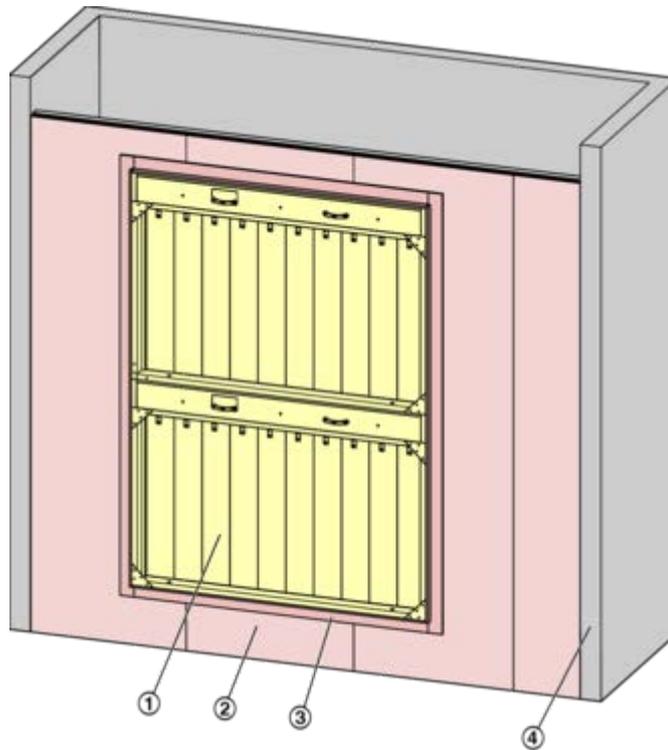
Exemplo de montagem EK-JZ Dry em parede leve (apenas gesso) aplainada num dos lados EI 120 S
